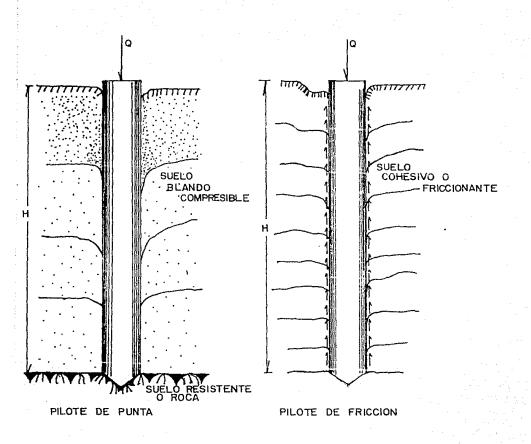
PILOTES DE PUNTA Y FRICCION.
